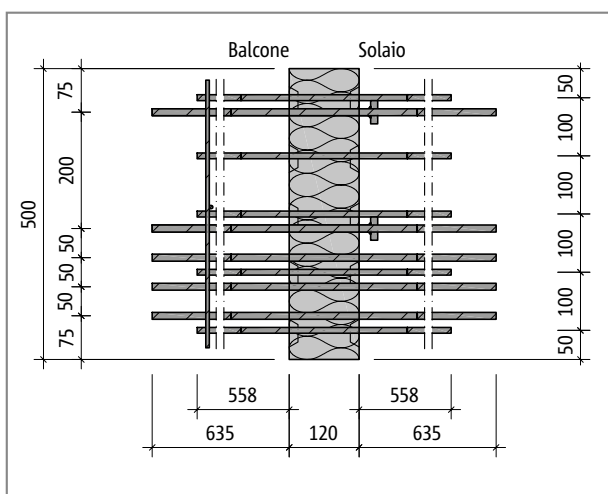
Schöck Isokorb® tipo EXT30-R-V10: pianta del prodotto
